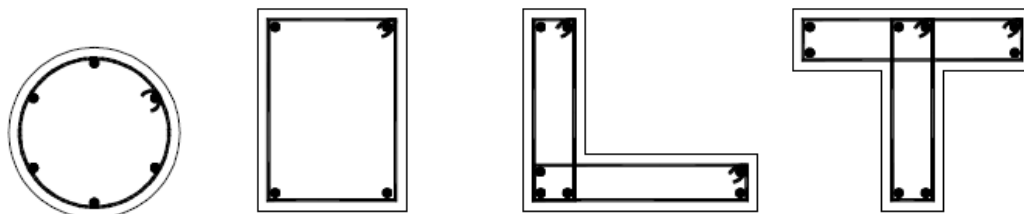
Disposições das barras longitudinais mínimas para diversas seções
